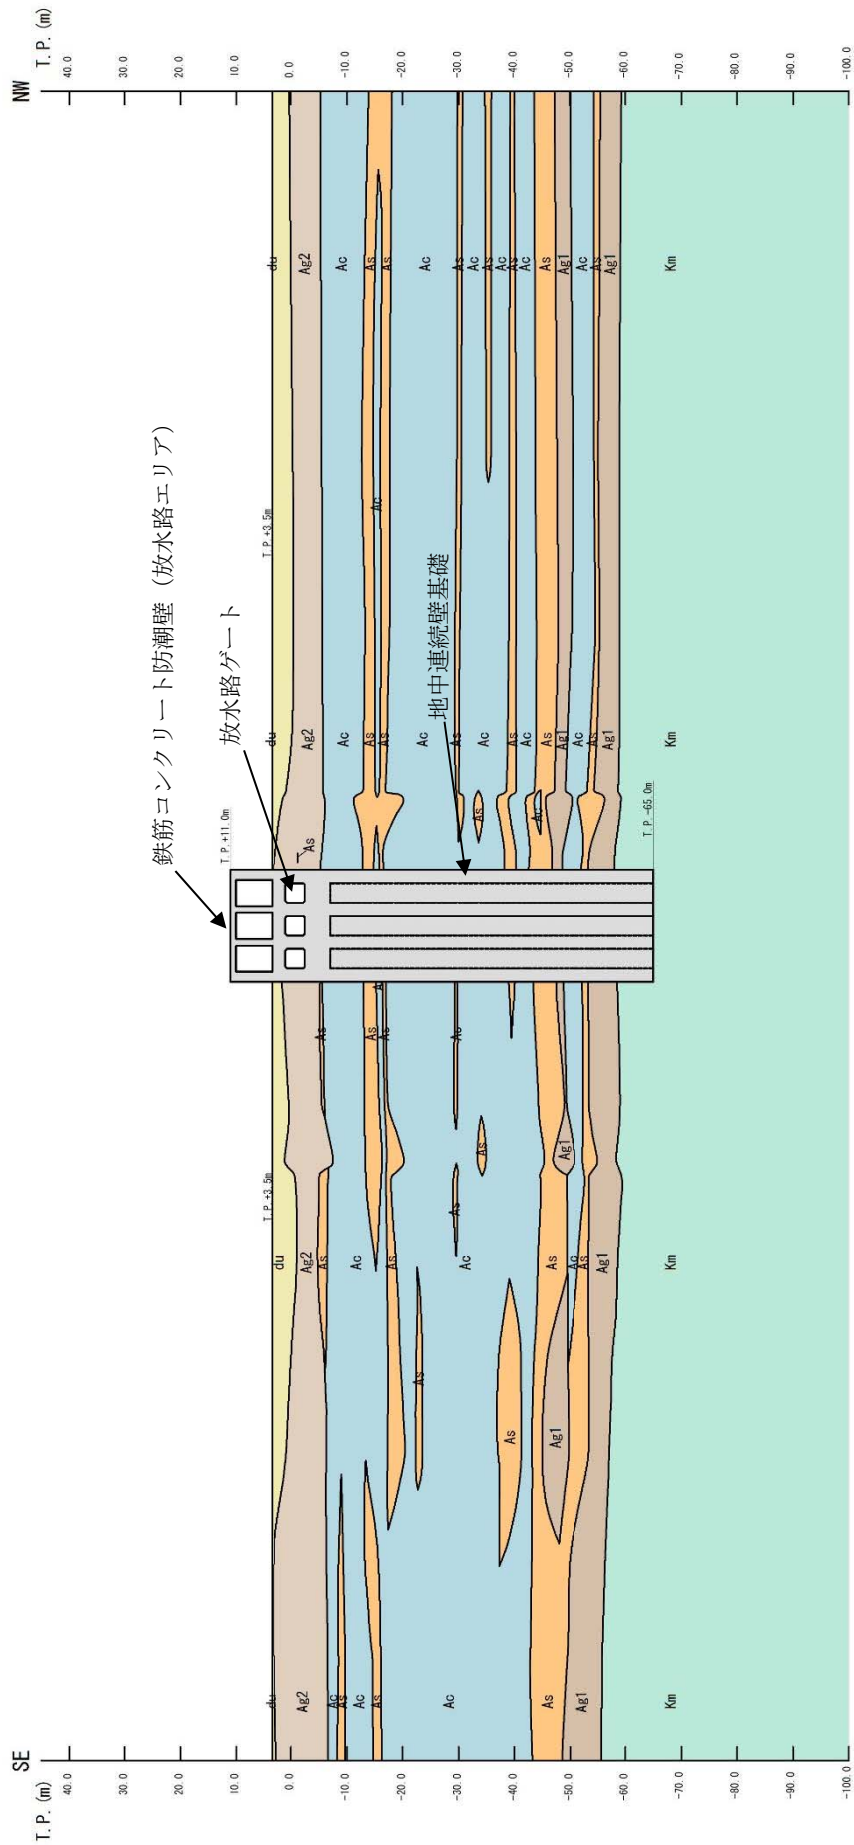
(3) 鉄筋コンクリート防潮壁 (放水路エリア) の評価対象断面図 (防潮壁縦断方向：③-③断面, ゲート部)
